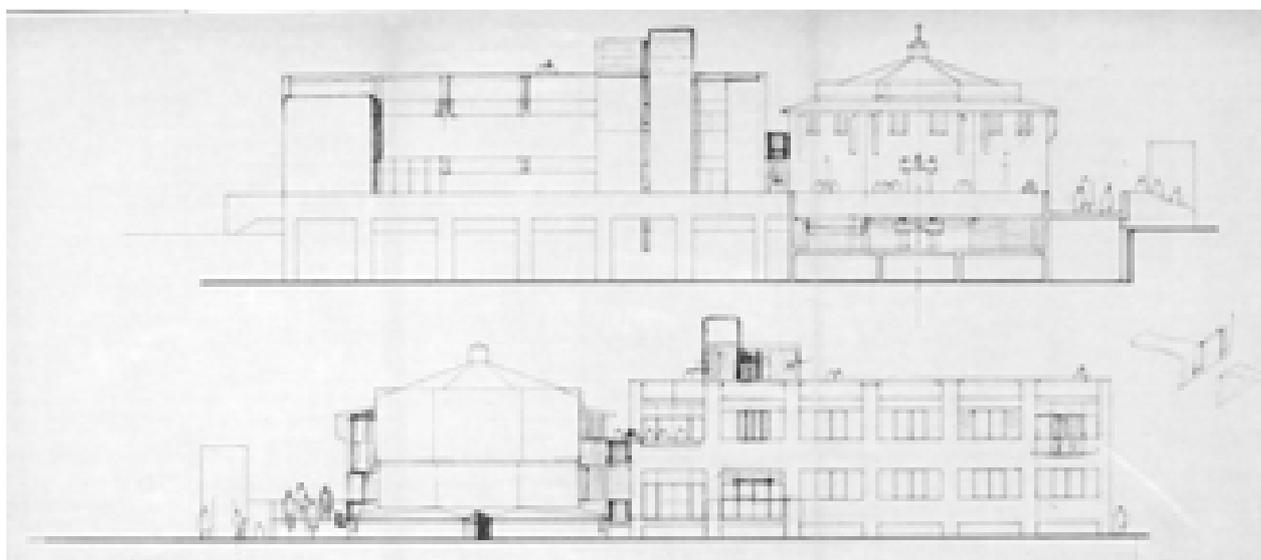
Prospetto Est-Ovest, stato futuro – 28/03/1995 (AABS-64_1080)
